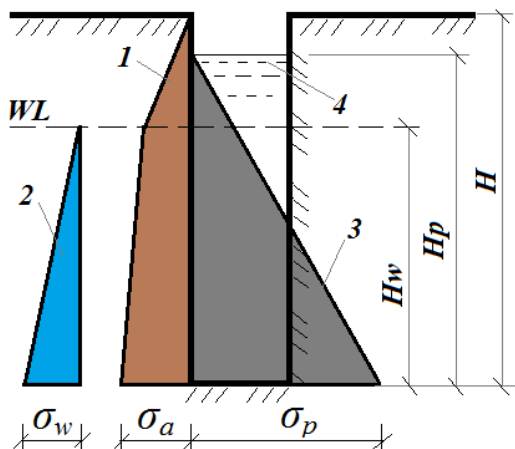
Расчетная схема к расчету устойчивости стен траншеи
